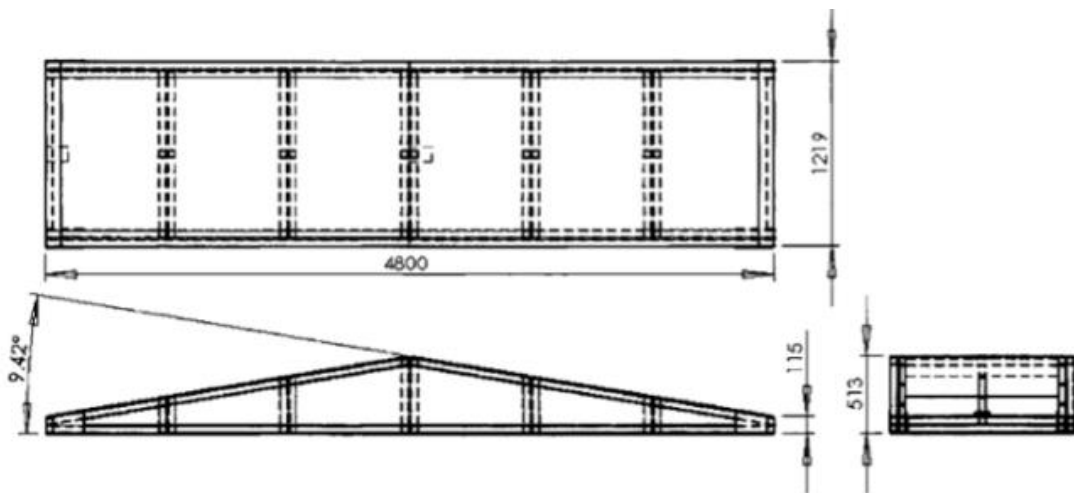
Vista superior e em elevação de um piso de rodagem (dimensões em mm)
